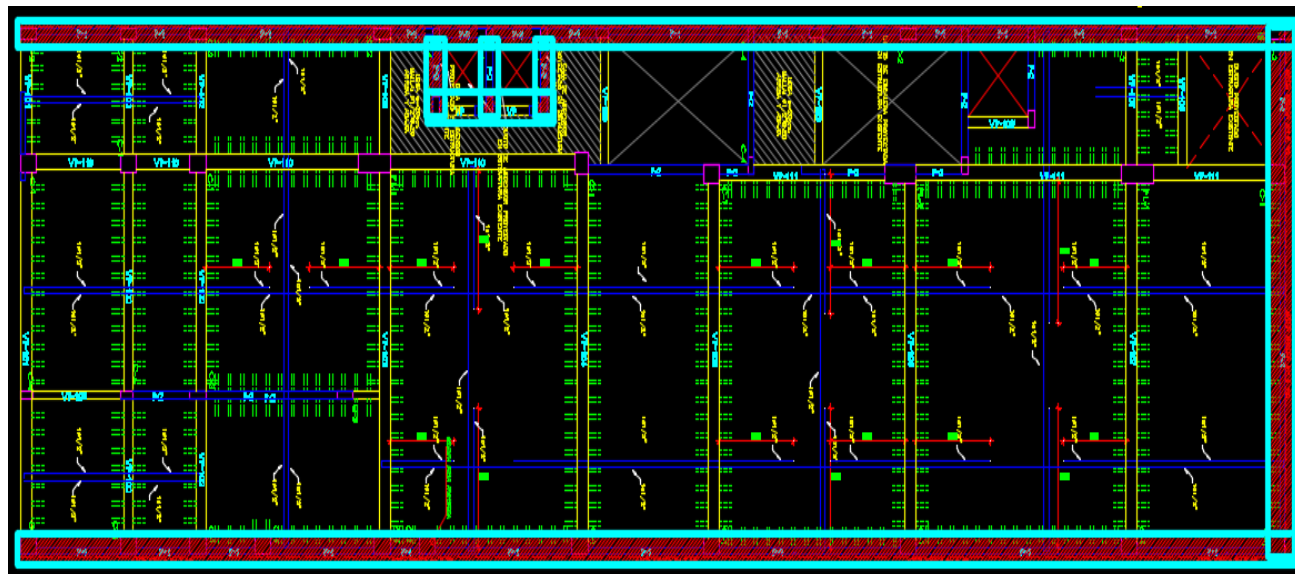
Sección de las placas sombreada en rojo para la evaluación del proceso de oxidación en las barras verticales (Fuente Galusa sac)
